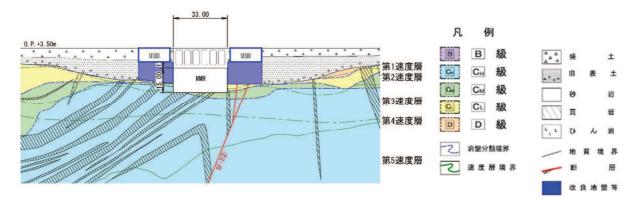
地盤改良体の配置図(取水口, A-A 断面)
